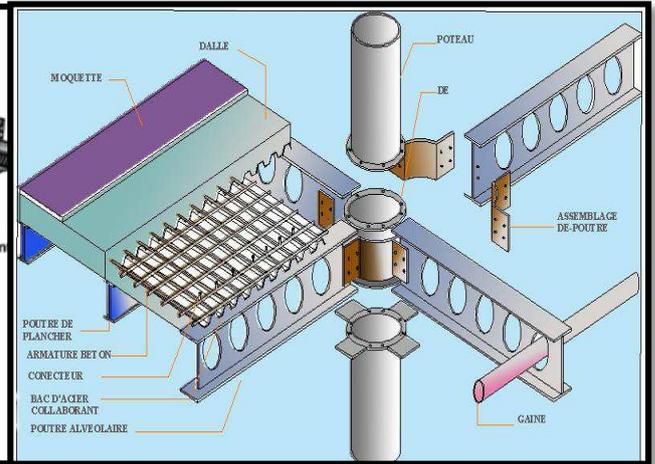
Détail de la jonction Poteau, Poutre, plancher collaborant
